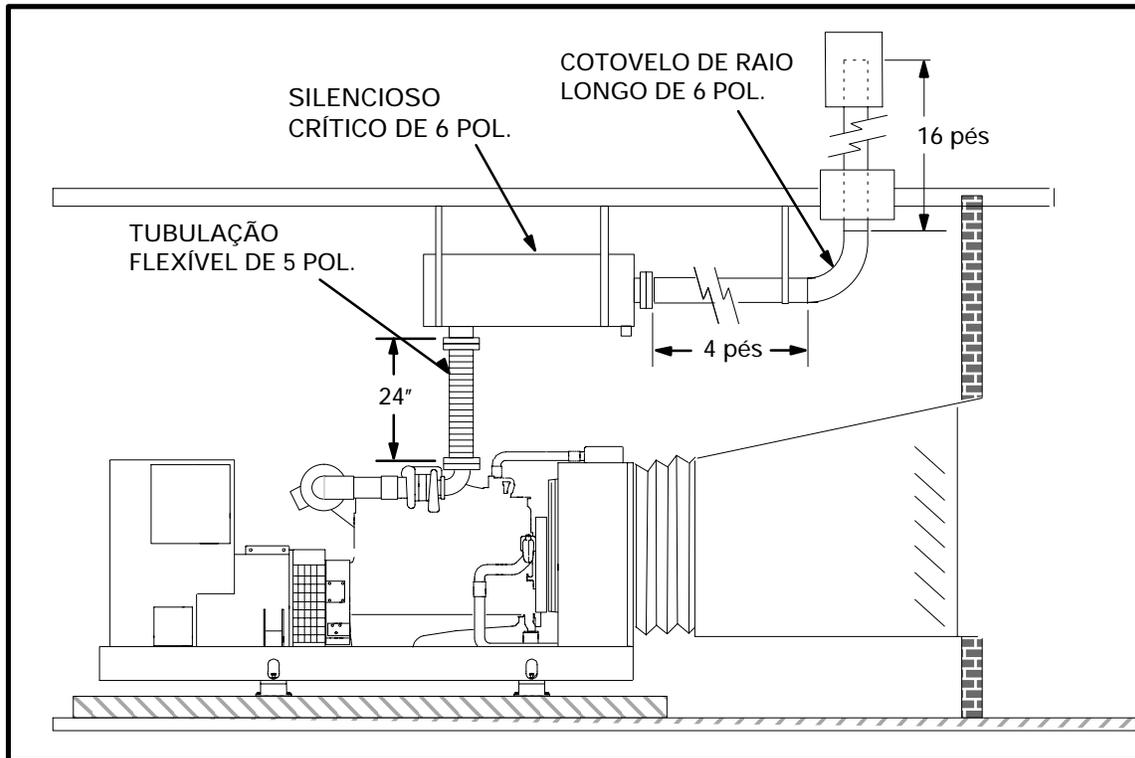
Exemplo de Sistema de Escape para Cálculo
